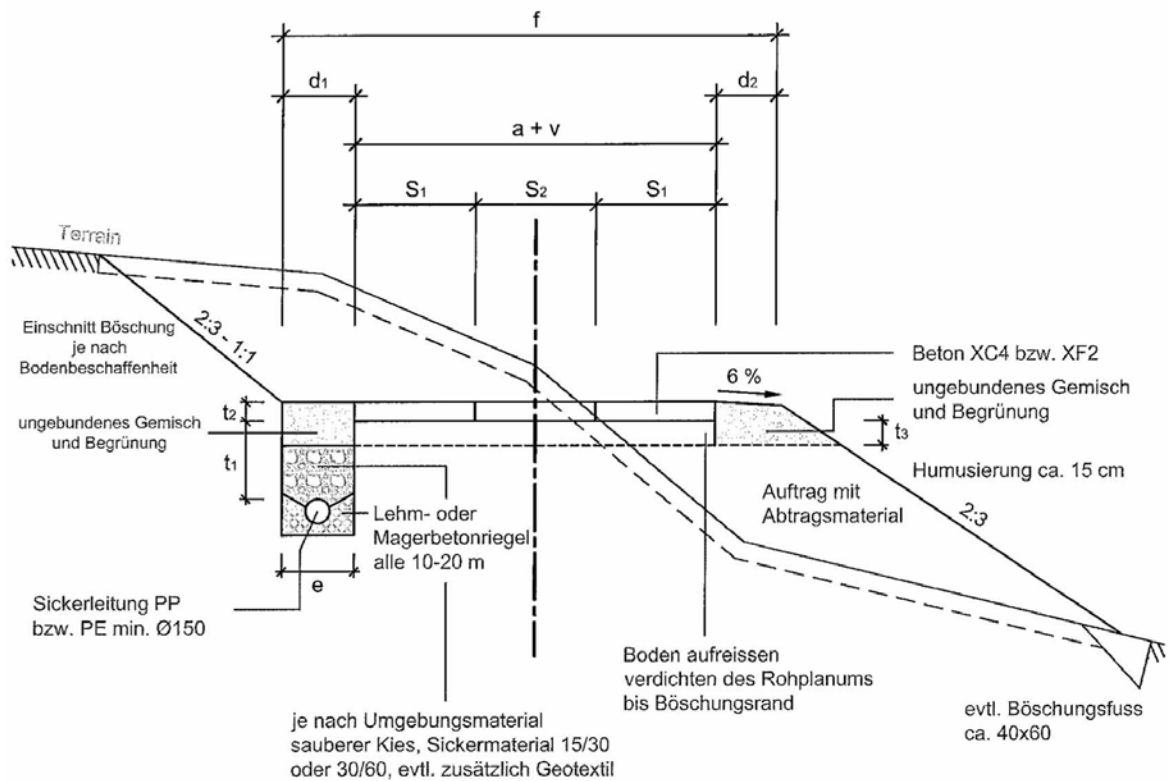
Starrer Oberbau – Einschnitt und Auffüllung (mit Entwässerung)
